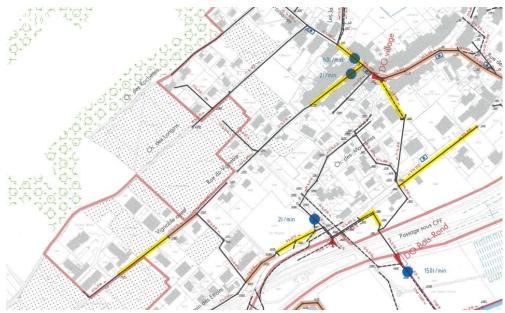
Collecteurs dont leur capacité hydraulique est dépassée, en jaune (Source : PGEE Cornaux, 2003)
